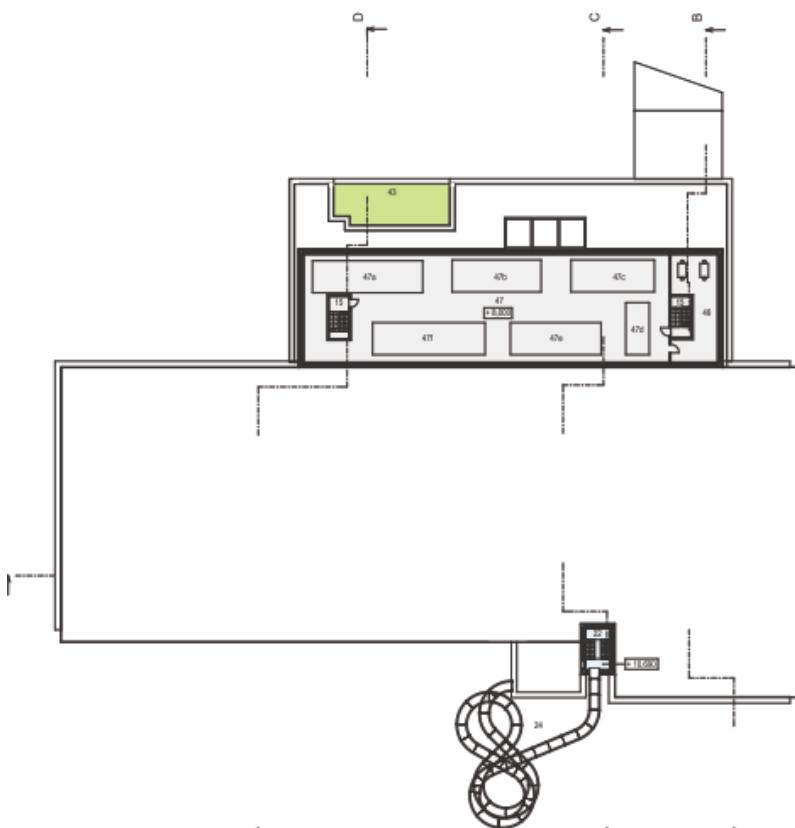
Situace areálu (zdroj:Wach s.r.o.)
